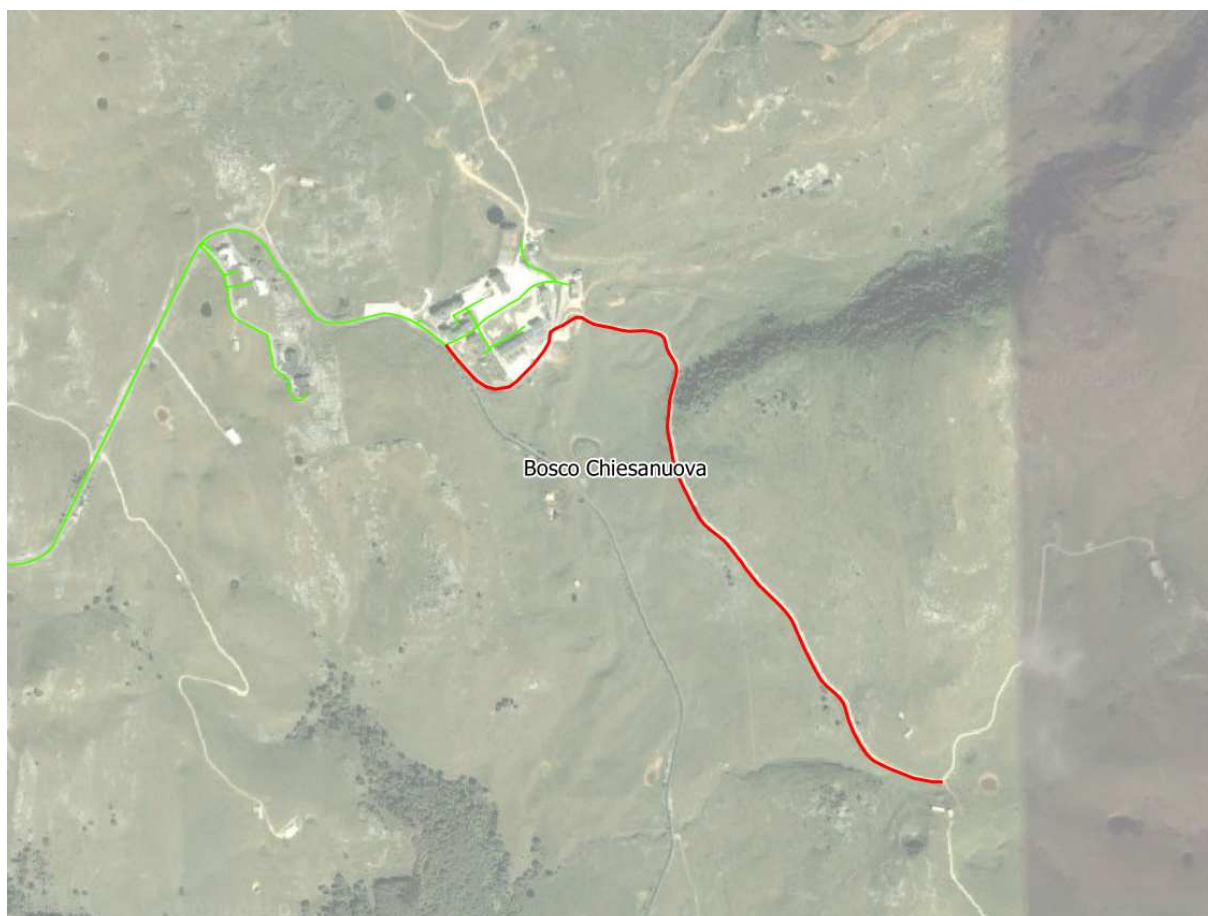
Planimetria generale del tracciato GH. In rosso il tracciato di progetto, in verde la rete esistente.
